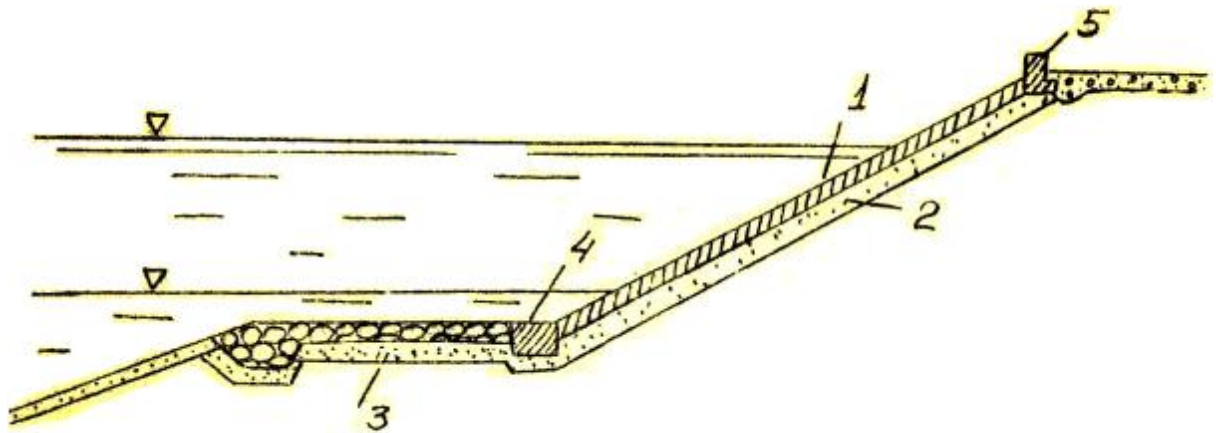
Схема конструкції укісного кріплення з монолітного або збірної залізобетону з підготовкою основи
